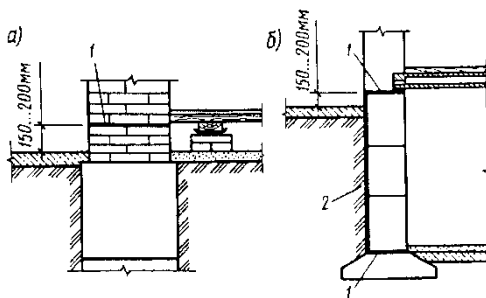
Изоляция стен от сырости и капиллярной влаги:
